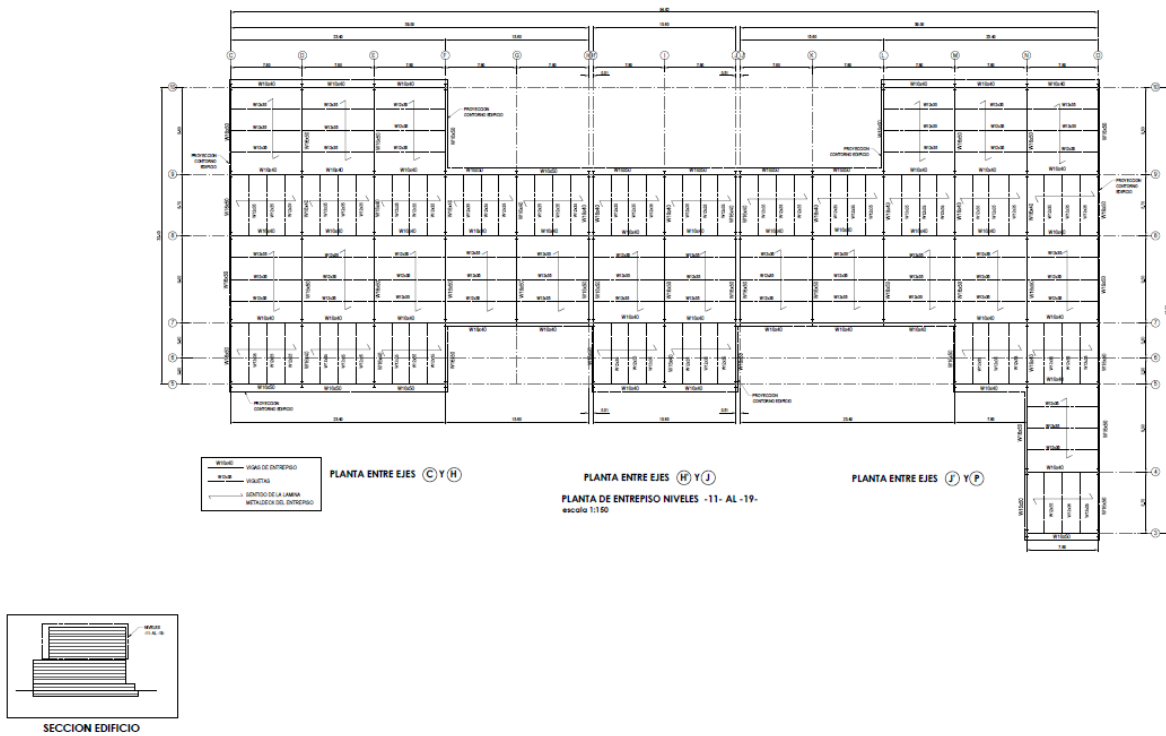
Planta Estructural Entrepiso Nivel 11-19
